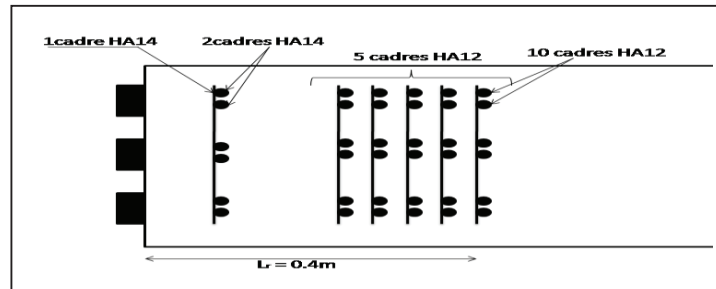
Ferraillage de la zone d'encrage de l'about
